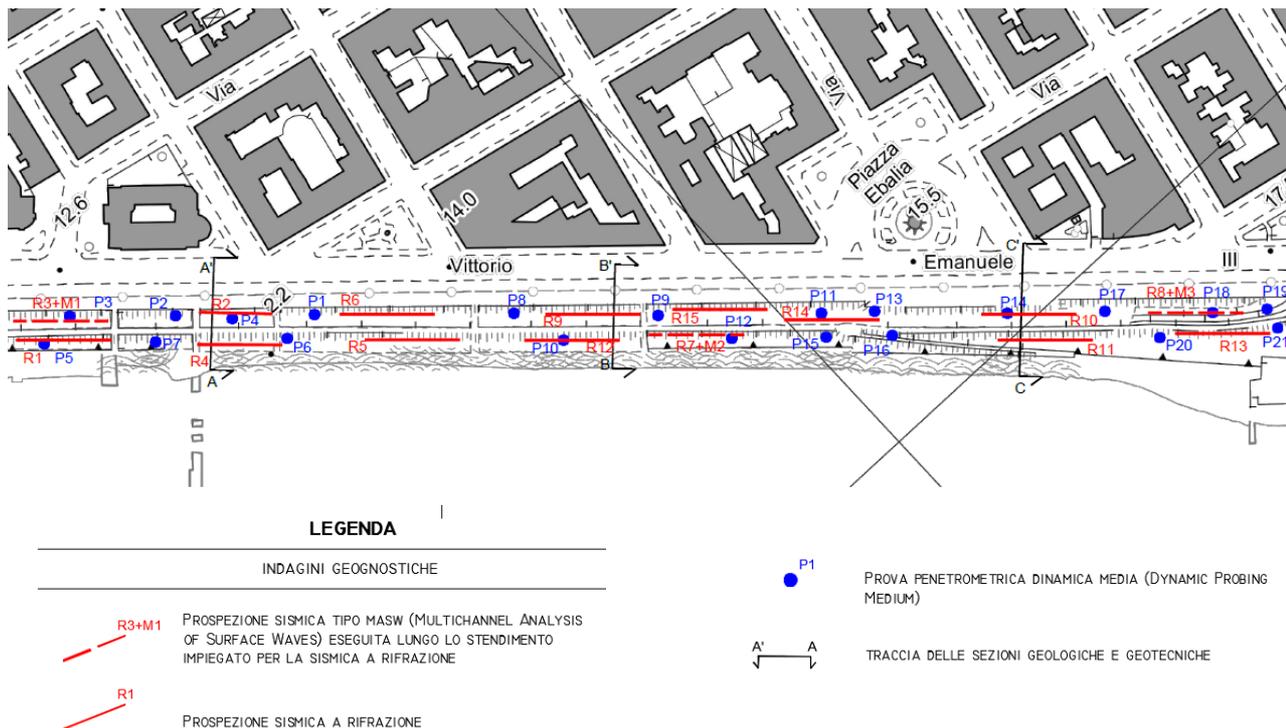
Stralcio planimetria ubicazione indagini eseguite per il presente progetto.
